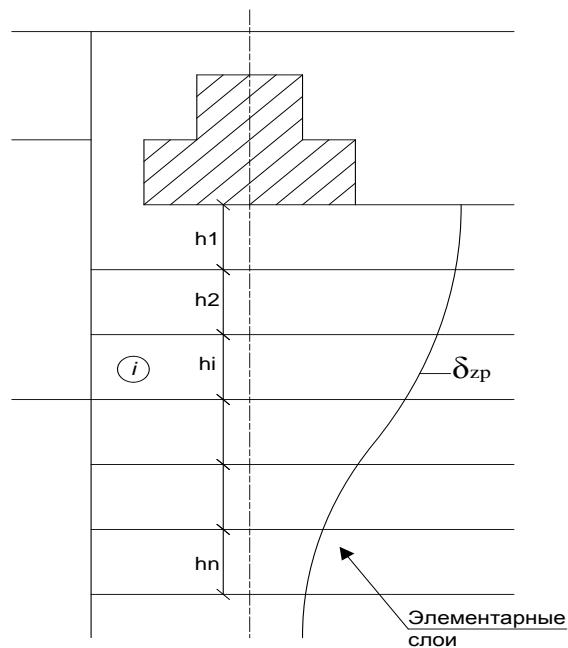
Расчетная схема к определению осадки фундамента методом послойного суммирования
